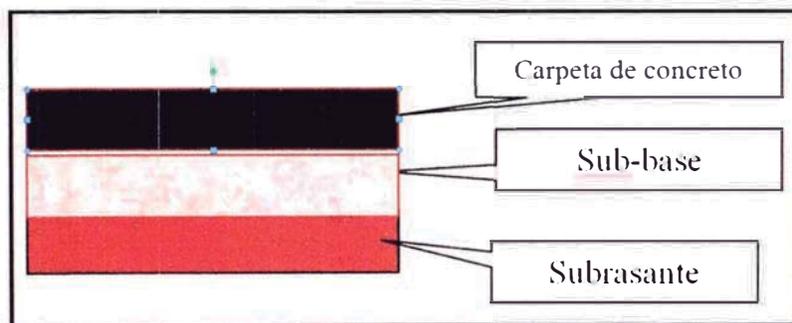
Estructura de un Pavimento Rígido.
